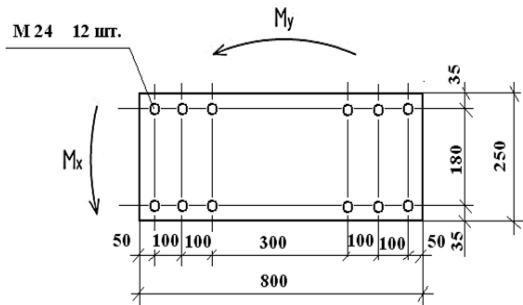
Расчетная схема болтового соединения оголовка (рекламного поля) конструкции
